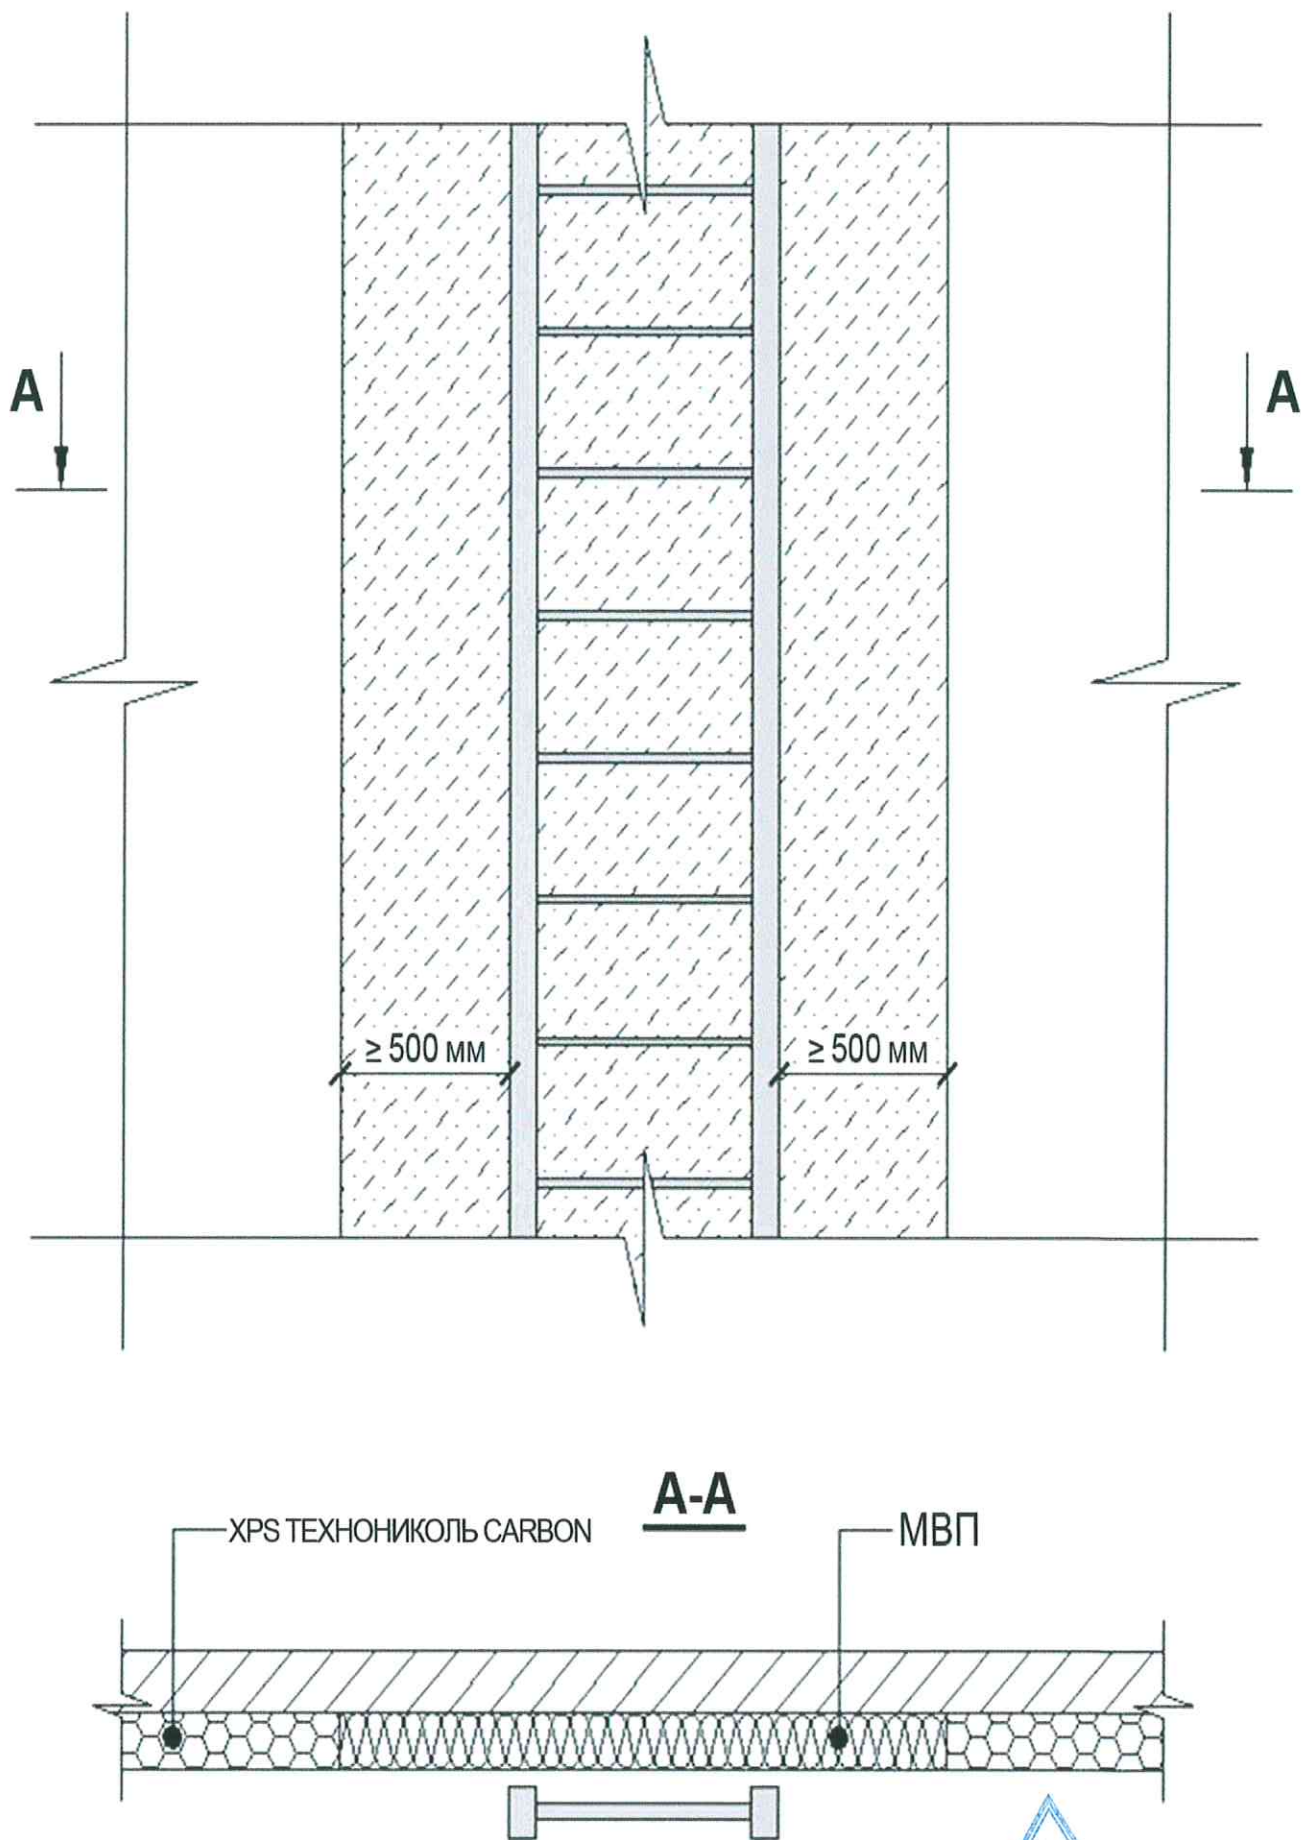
Участки примыкания СФТК к пожарной или наружной маршевой лестнице здания
